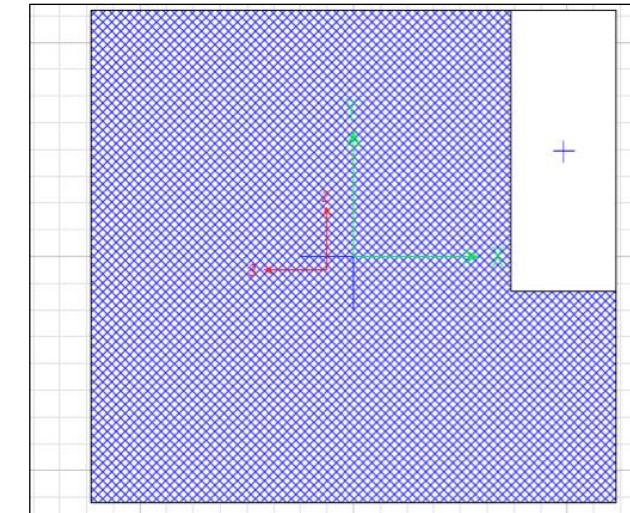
a. Introducción en SAP de la sección de la viga en L
